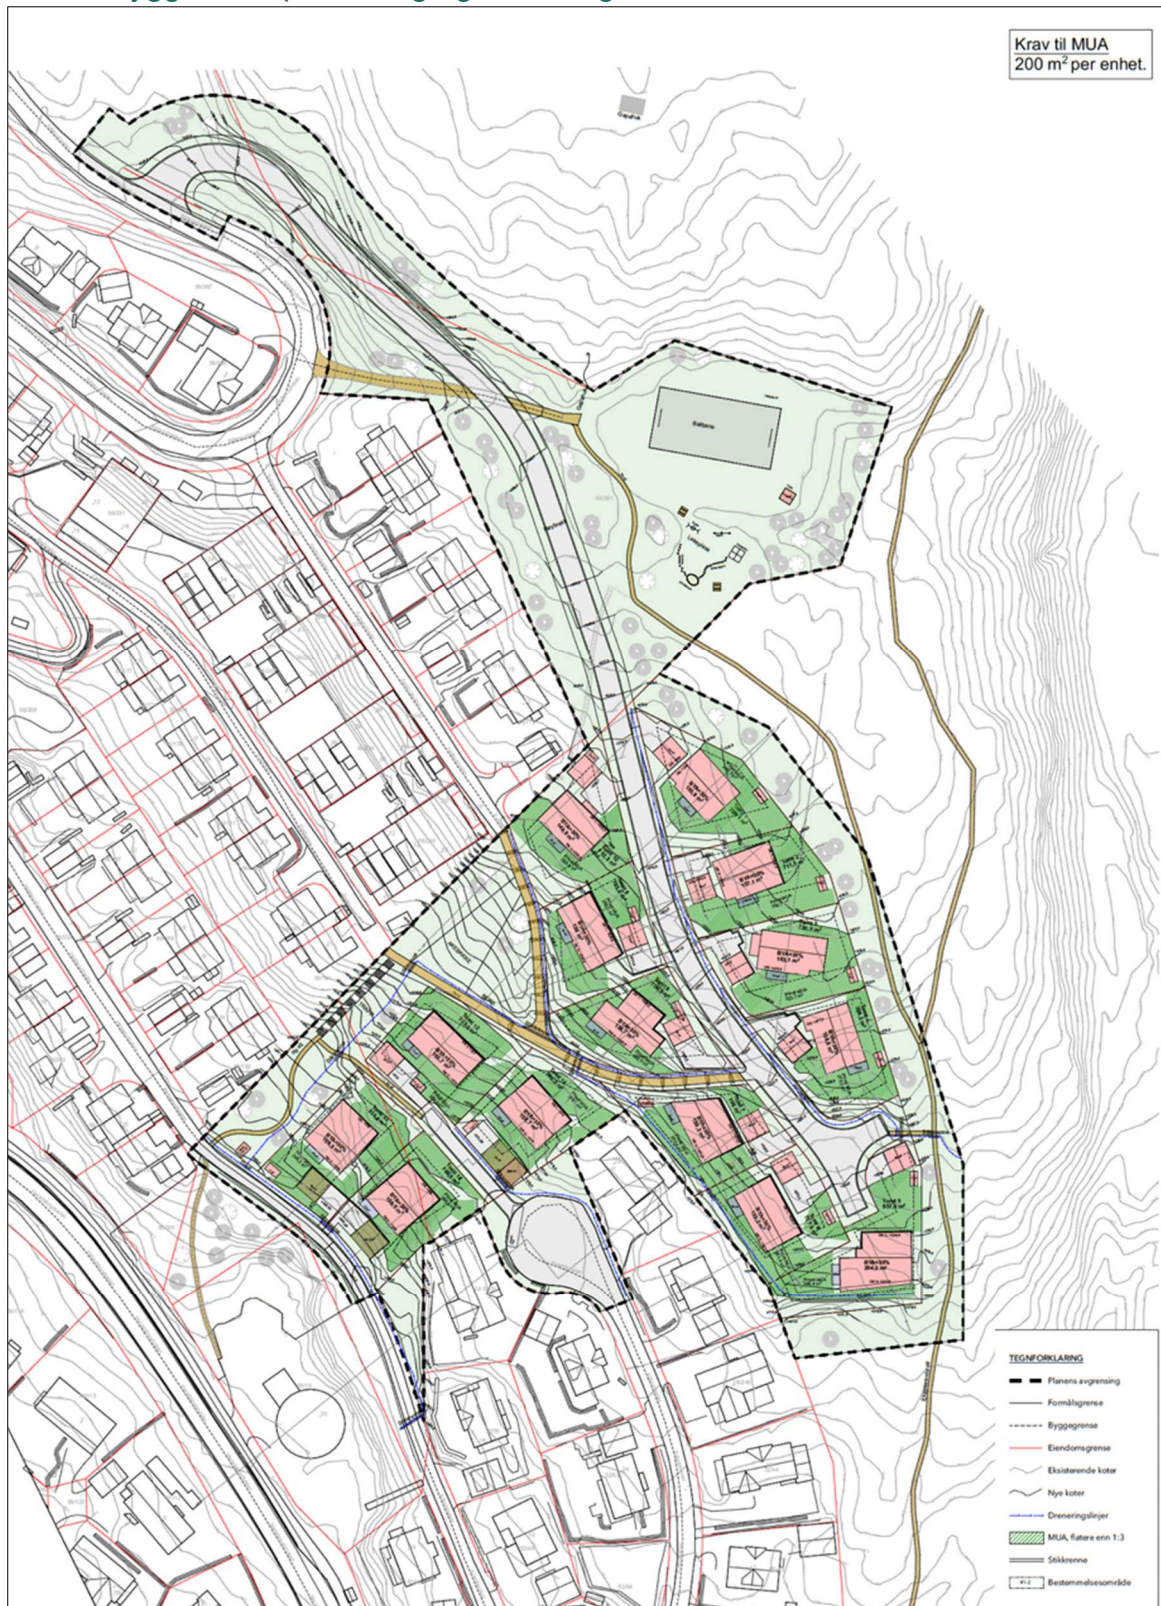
Illustrasjonsplan, viser mulig plassering av boligbebyggelse innenfor planområdet
